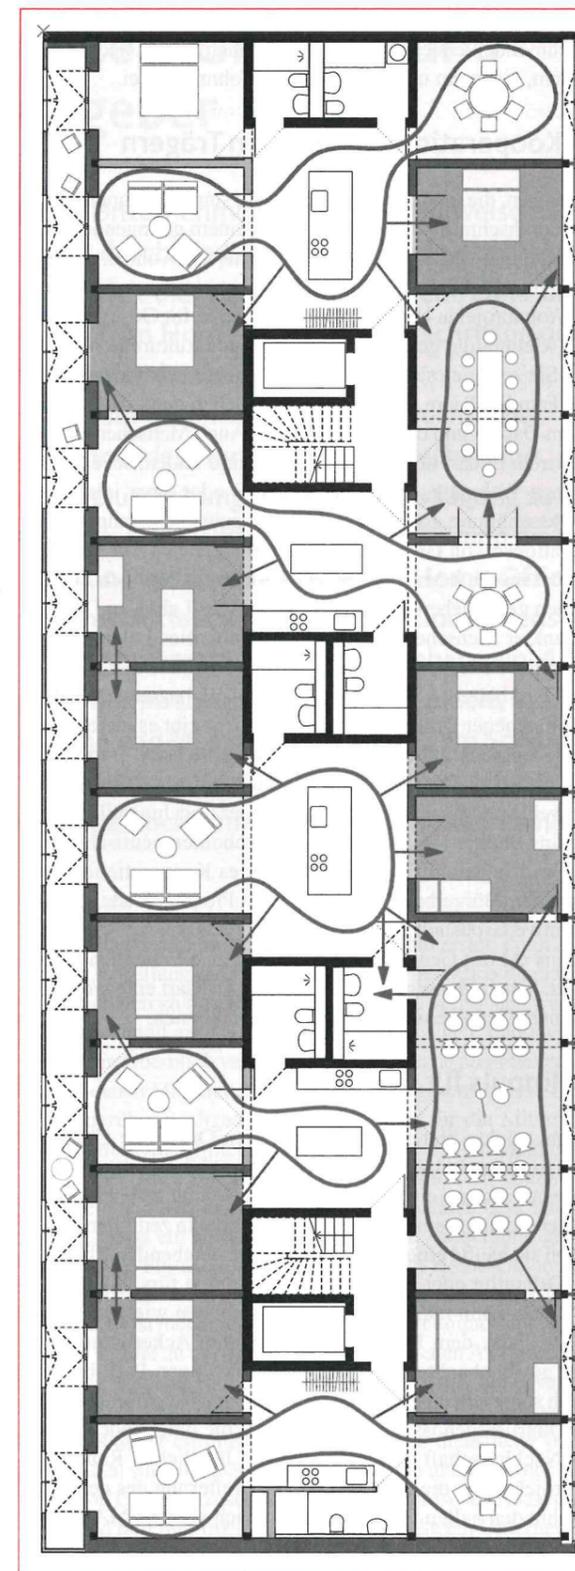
flexibler Grundriss San Riemo, kooperative Großstadt eG, Urheber: ARGE summacumfermer Büro Juliane Greb
